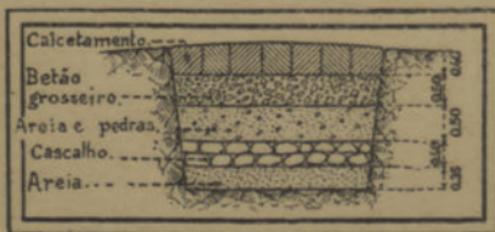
Vista em corte mostrando a construção duma estrada romana
